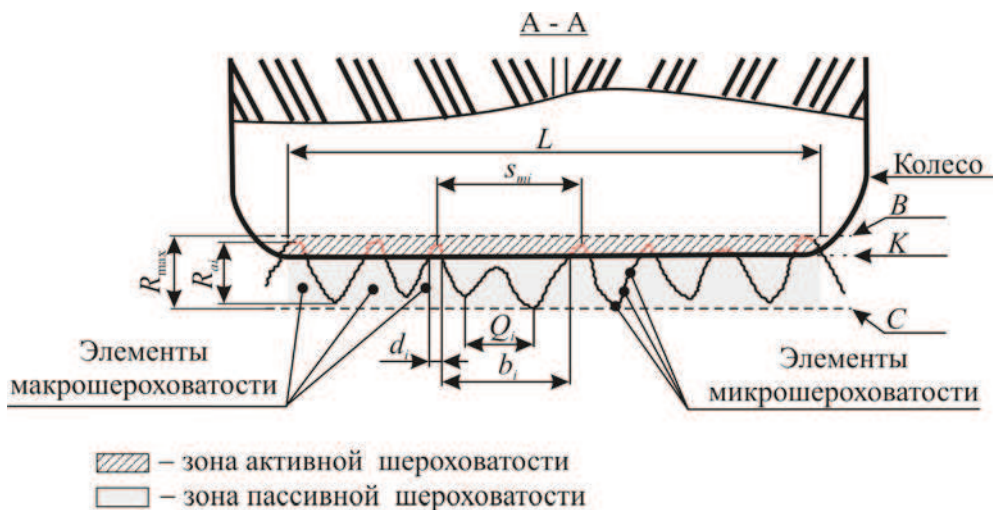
Схема нанесения борозд или углублений на поверхности покрытия: K – плоскость контакта поверхности колеса автомобиля с элементами шероховатости; C – плоскость наибольших впадин профиля шероховатости в зоне контакта поверхности колеса; B – плоскость наибольших выступов профиля шероховатости в зоне контакта поверхности колеса; l – базовая длина (180), мм; D_m – диаметр отпечатка протектора колеса расчетного автомобиля, мм; s_i – шаг местных выступов макрошероховатости в пределах базовой длины, мм; s_{mi} – шаг контакта шины автомобиля с поверхностью покрытия в пределах базовой длины, мм; R_{ai} – частная глубина впадин макрошероховатости, являющаяся вертикальным расстоянием между смежными вершиной и впадиной макроэлемента шероховатости, мм
